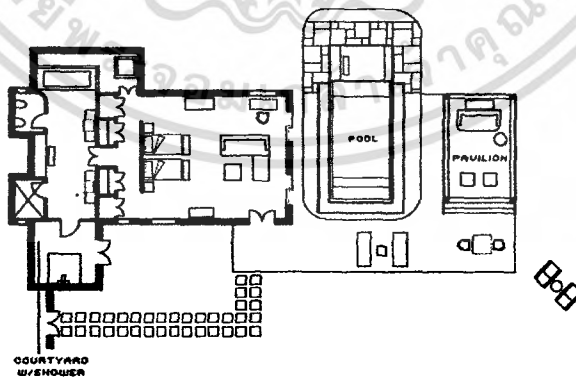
ตัวอย่างการจัดองค์ประกอบห้องพักแบบ Garden View Pavilion
